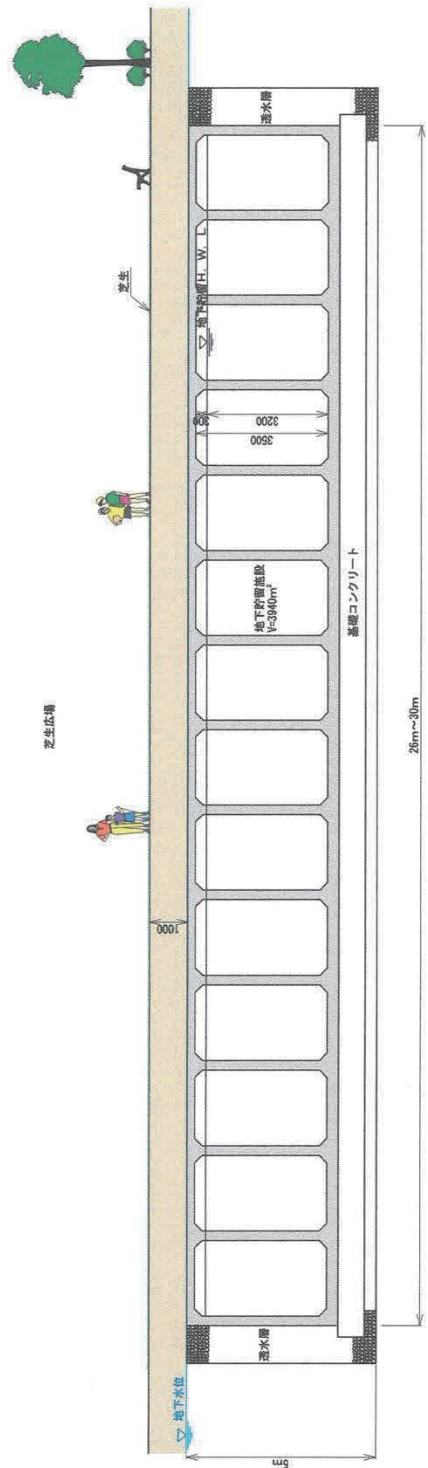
(1) 調整池 (3) 平面図 (3号公園)
